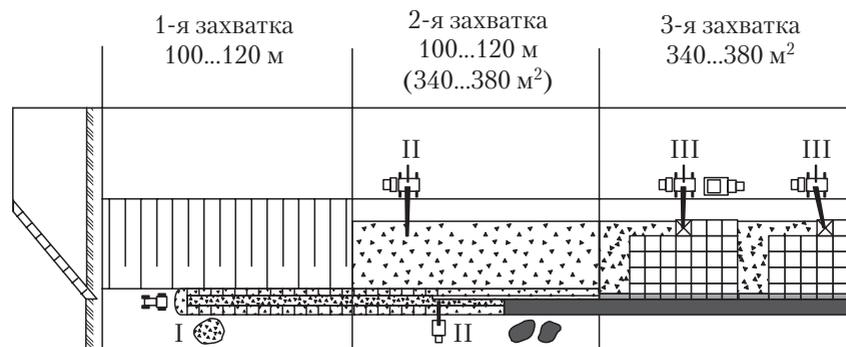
Схема производства работ по укреплению откосов сборными бетонными плитами:
